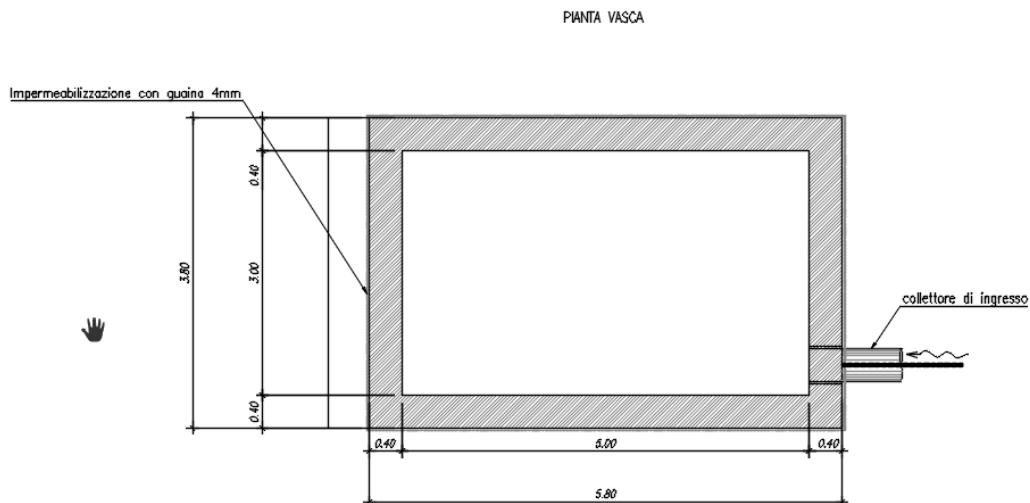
Pianta della vasca predisposta per l'impianto di sollevamento
